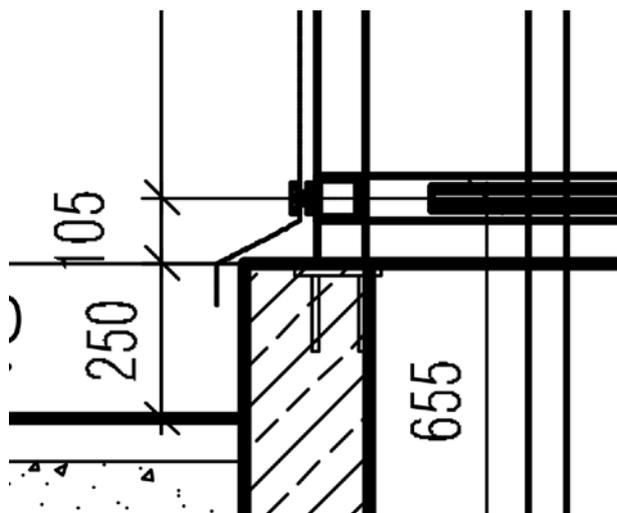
Detailansicht Anschluss Stahlkonstruktion – Fundament, o. M.
